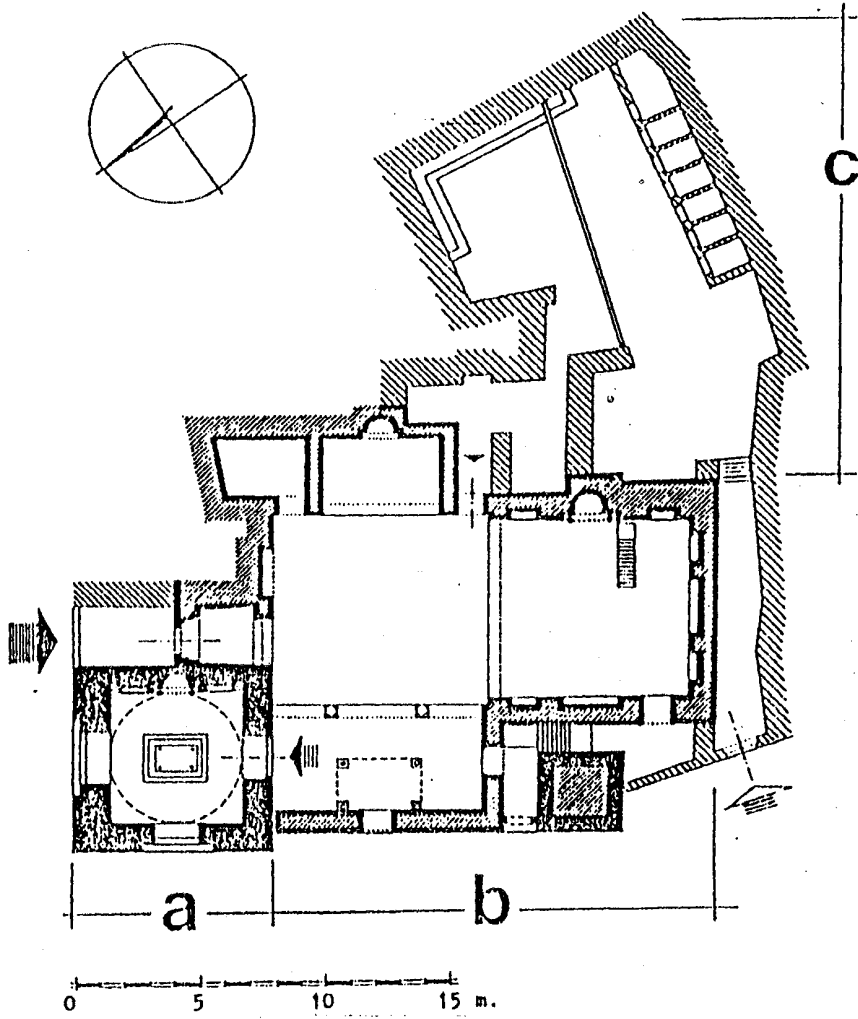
مسقط أفقي لمدرسة قطلوبغا الذهبي بالقاهرة
